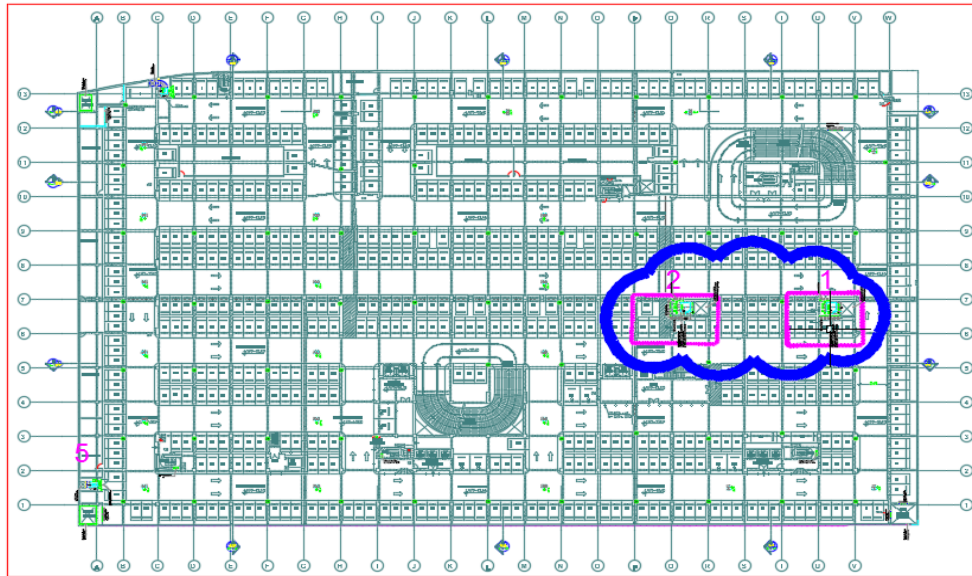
PLANTA GENERAL 4º SÓTANO
